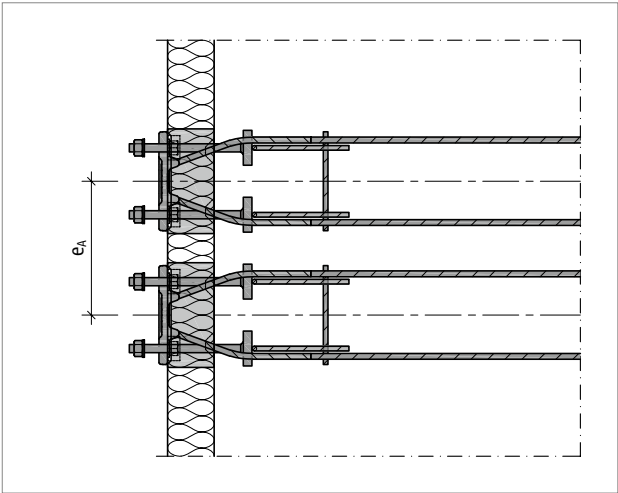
Schöck Isokorb® T type SQ : espacement axial
